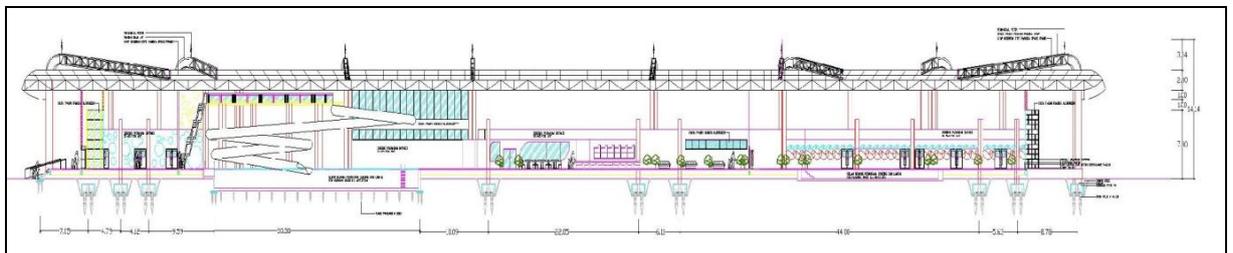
Denah Bangunan Rekreasi Gelanggang Olahraga Renang di Pontianak
